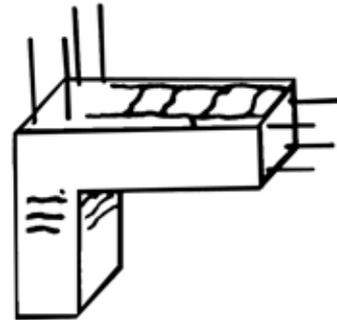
Fisuras por retracción hidráulica en una viga.
